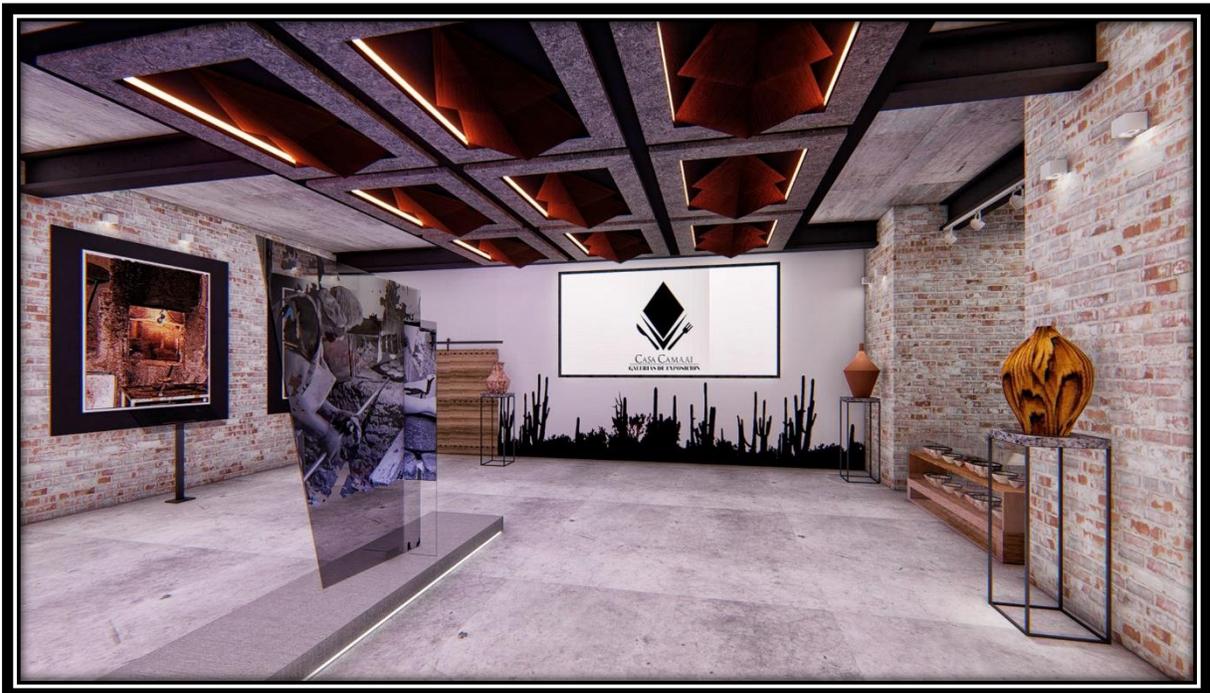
Sala de exhibición I. Planta baja. Fuente Propia.
